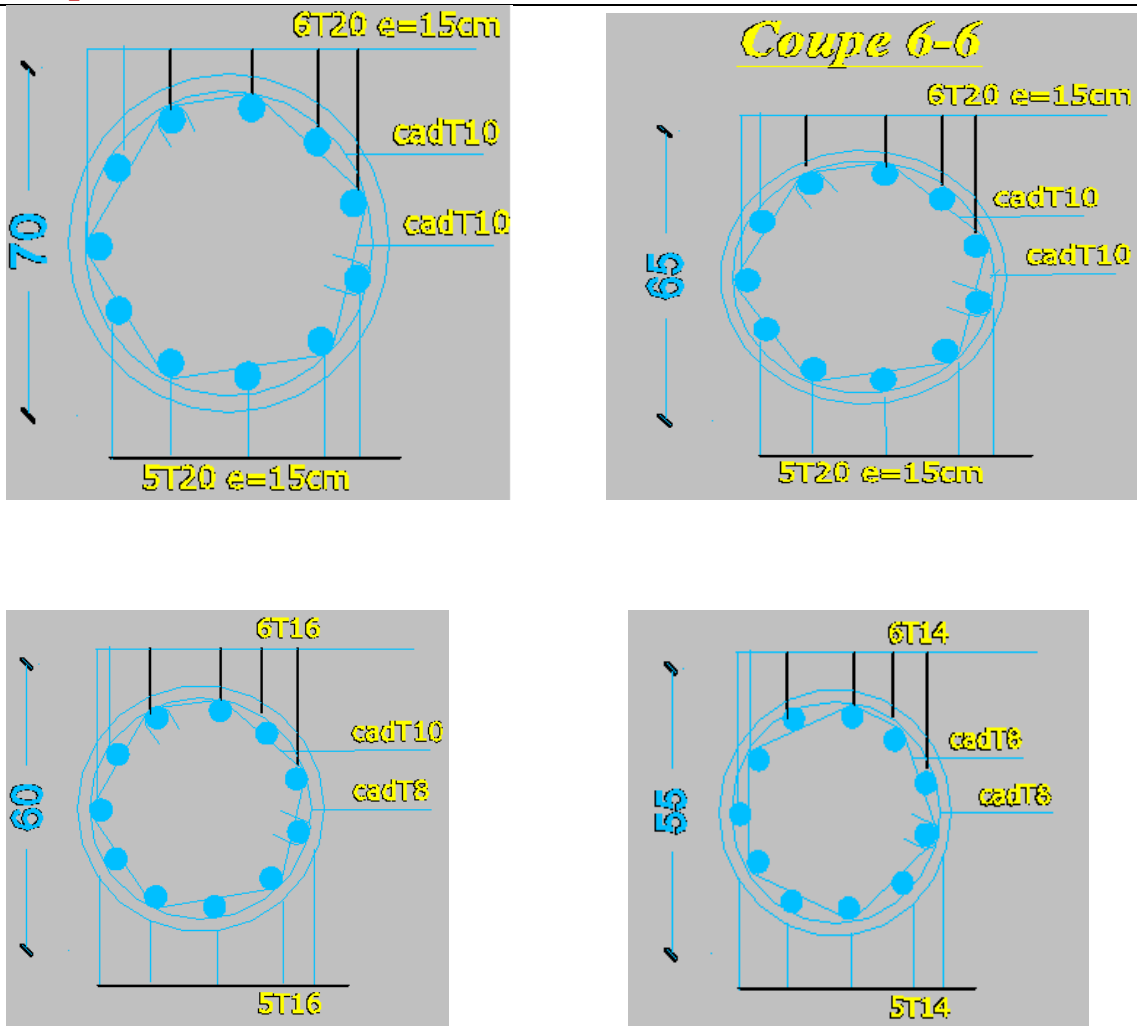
schéma explicite du ferrailage des poteaux circulaire
